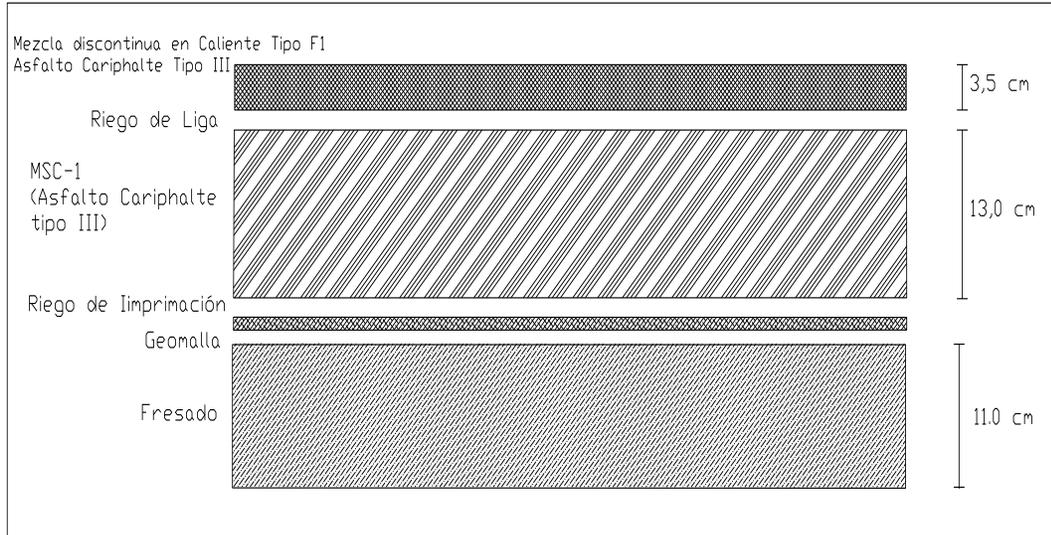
Estructura del pavimento hasta el Km 74+110
